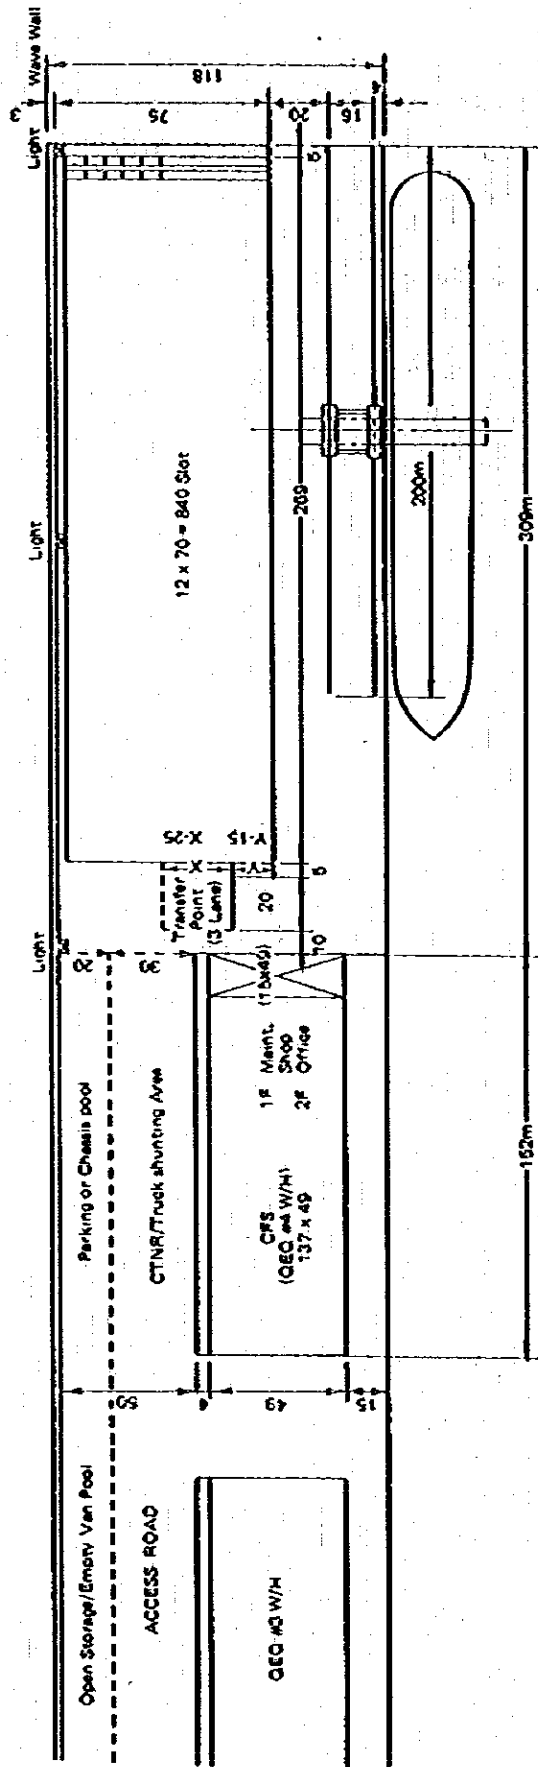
2 OEQ No.5 コンテナターミナル配置図 (トランスファクレーン方式)
